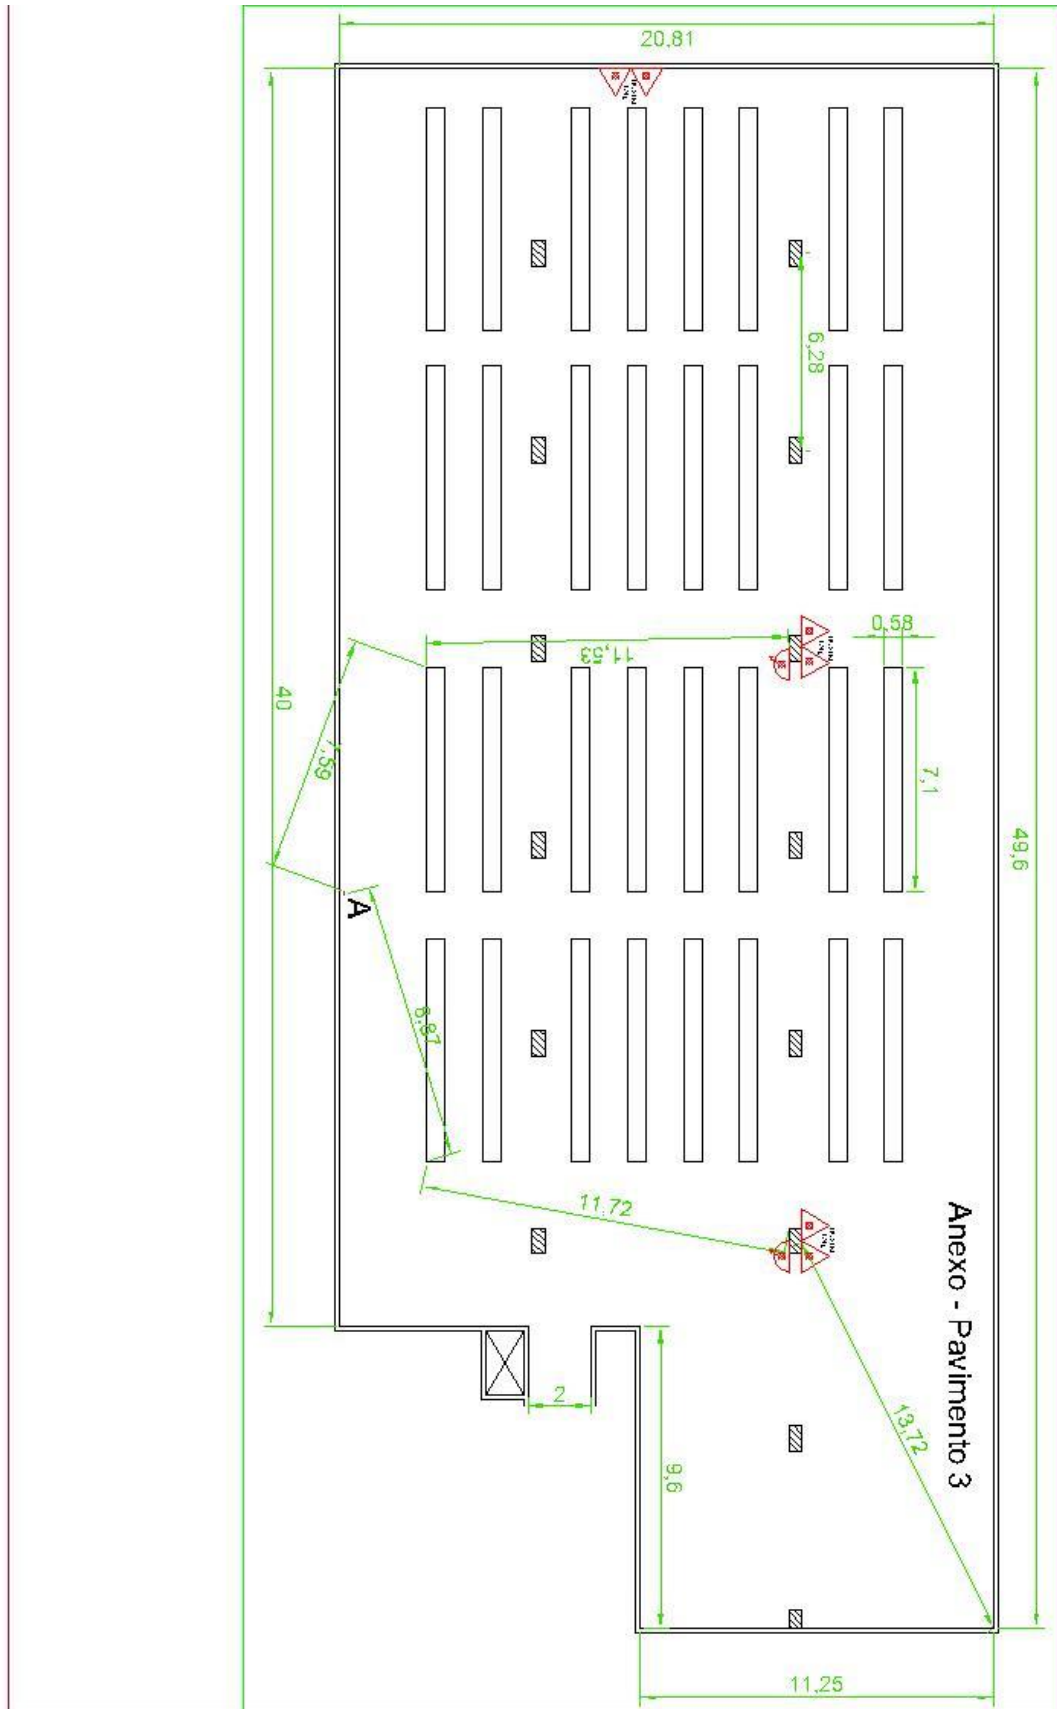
Posição dos extintores de incêndio e hidrantes na planta baixa do pavimento 3
